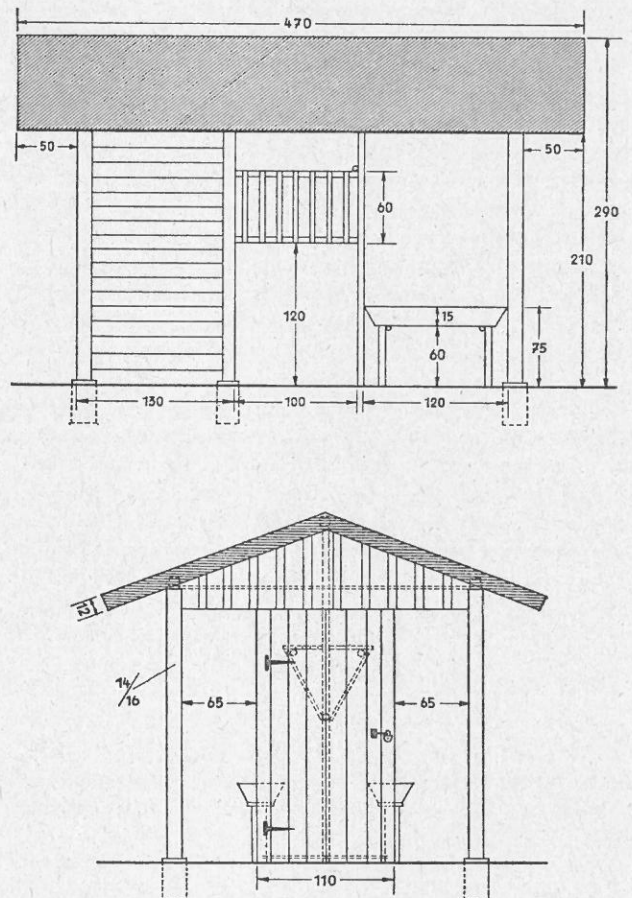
Fütterung für Rotwild im Schaugatter, Seitenansicht und Frontansicht, Maßangaben in cm.
